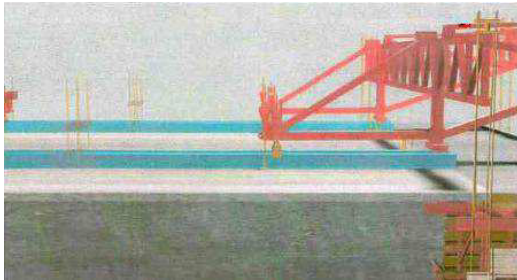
PROC – Colocação de armadura e colocação de negativos na laje superior [11]
